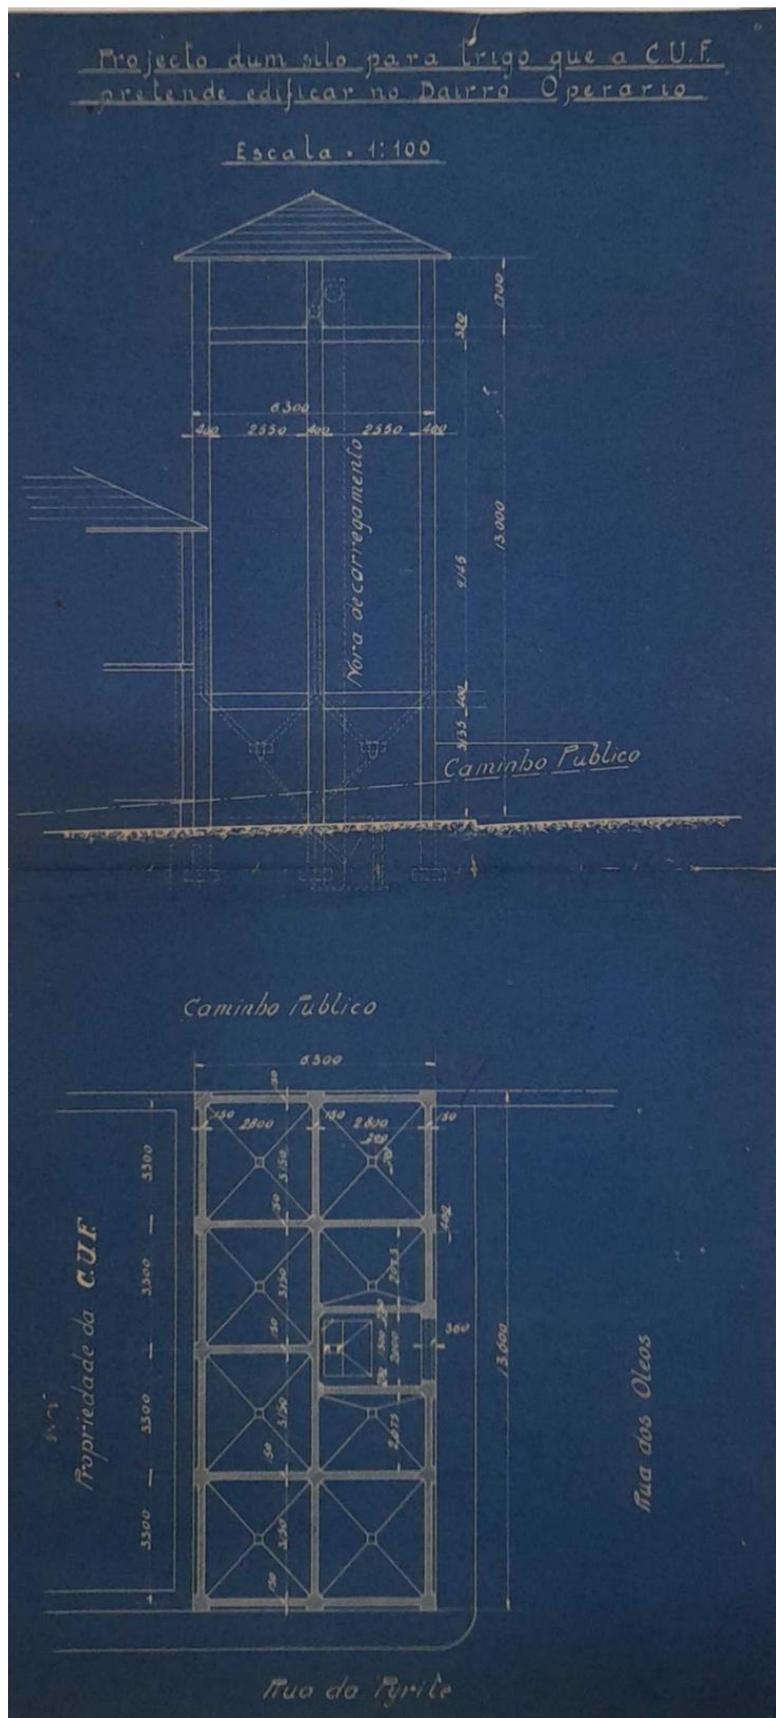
Alçado e Planta do Projeto de um Silo para trigo que a CUF contruiu no seu Bairro Operário
